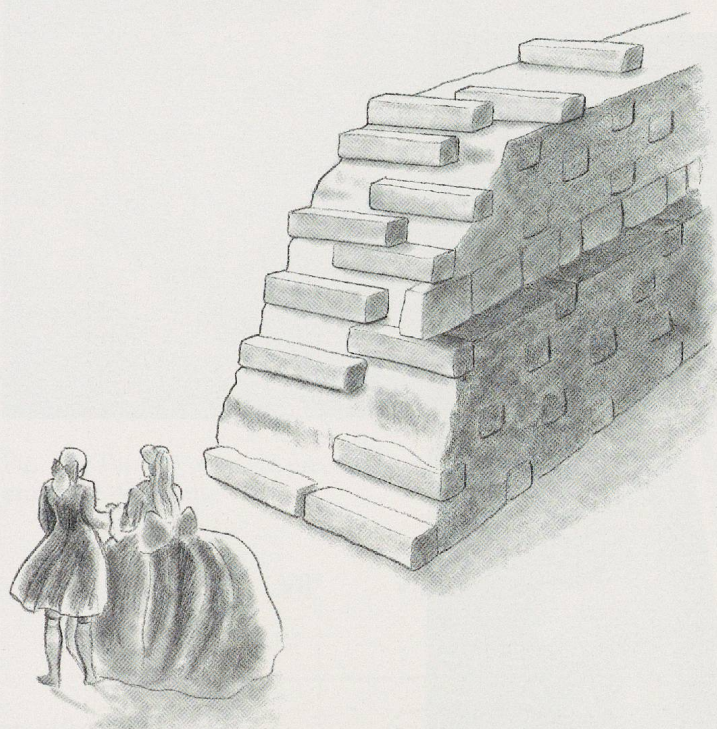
Restitution du système constructif du premier mur VI¹ de la terrasse est.
